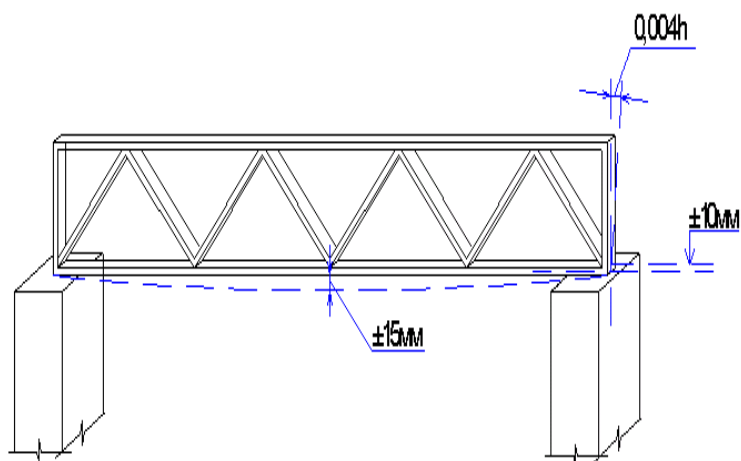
Схема предельных отклонений при монтаже ферм
